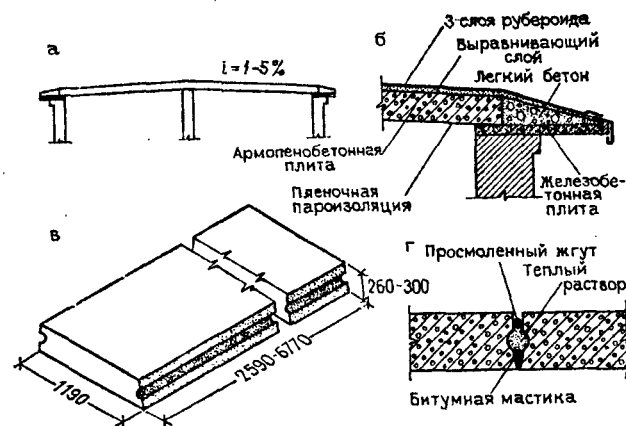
Бесчердачное неventилируемое покрытие с легкобетонными несущими панелями
